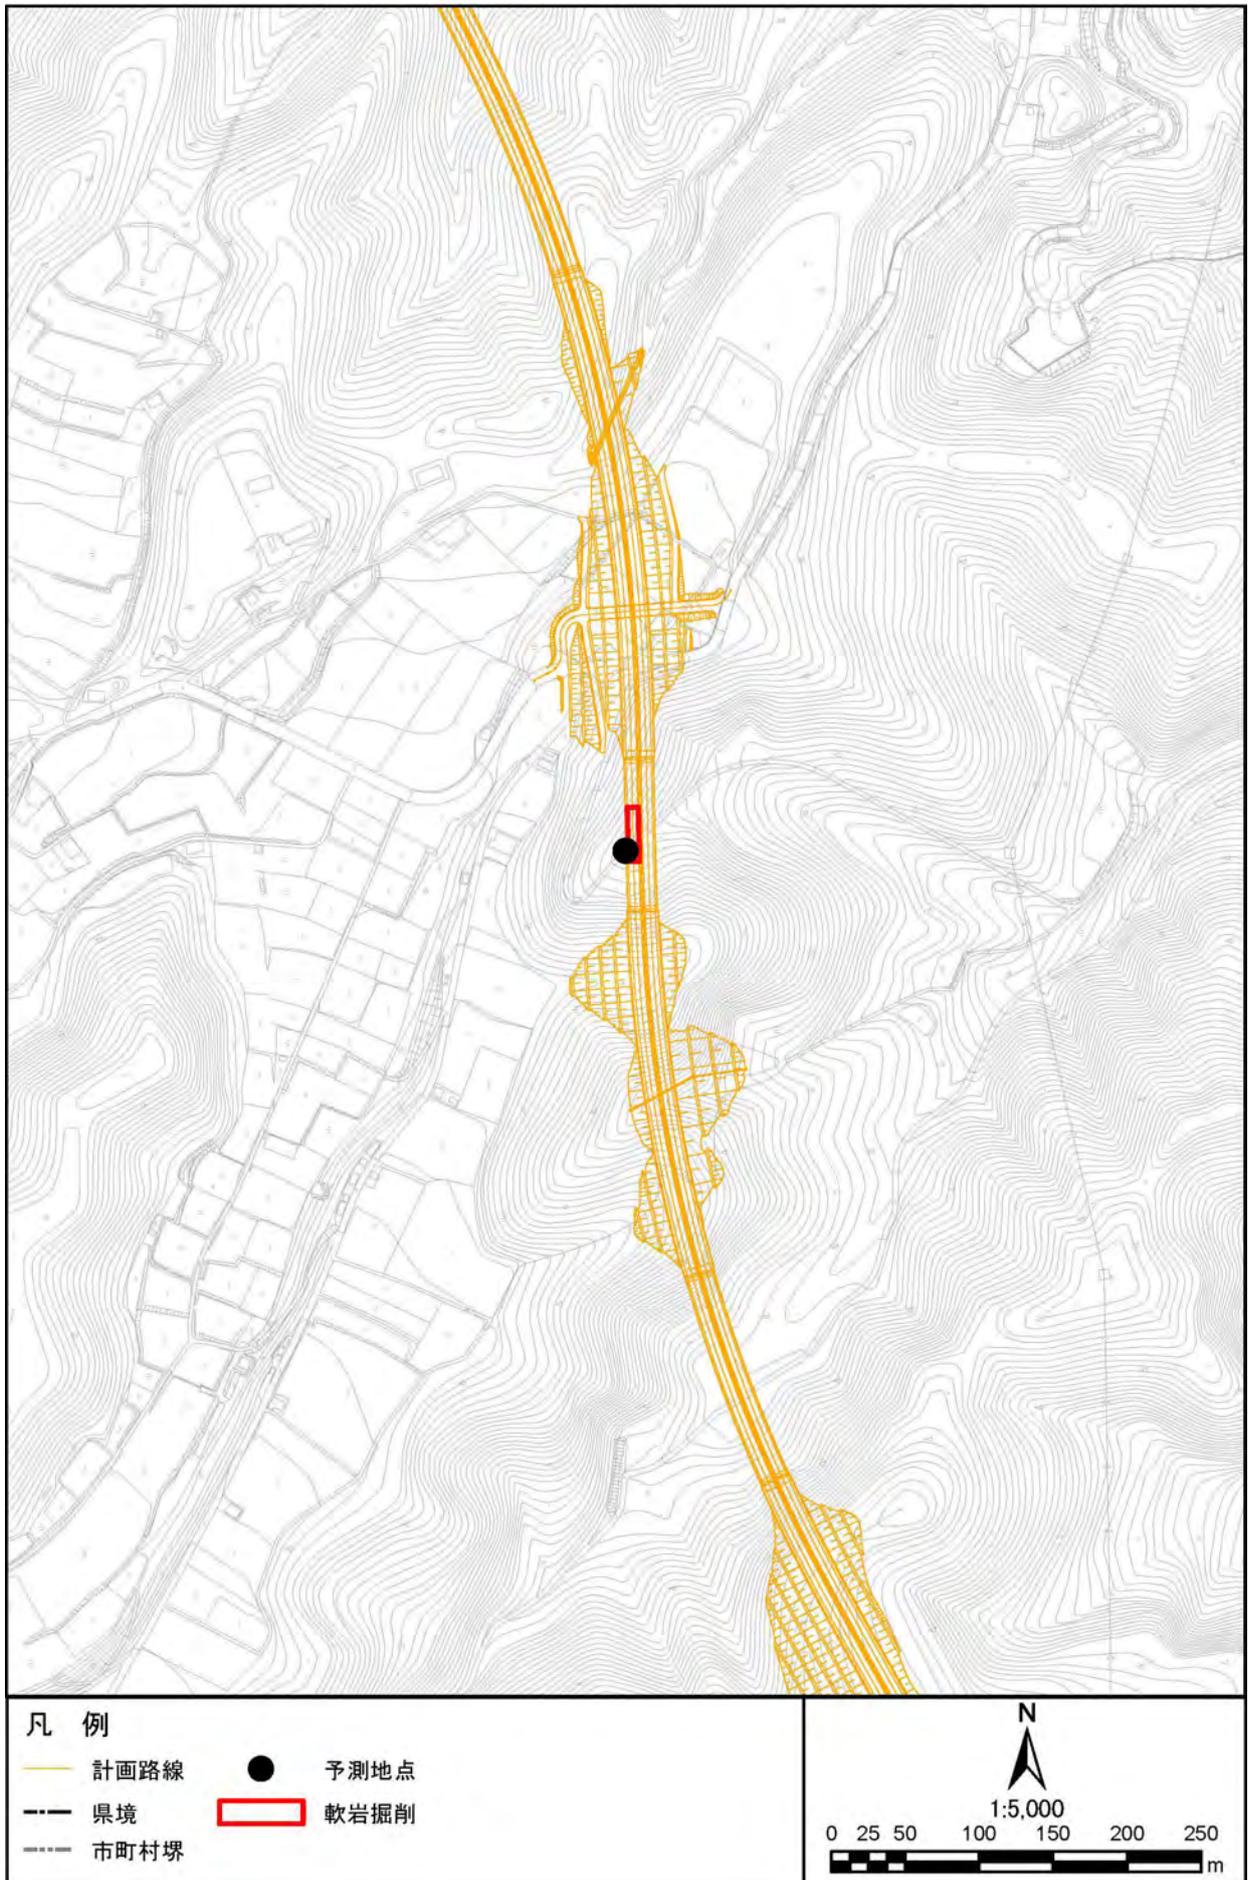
(8) 建設機械の稼働に係る振動のユニット配置図 (N8 小海町豊里 2)
